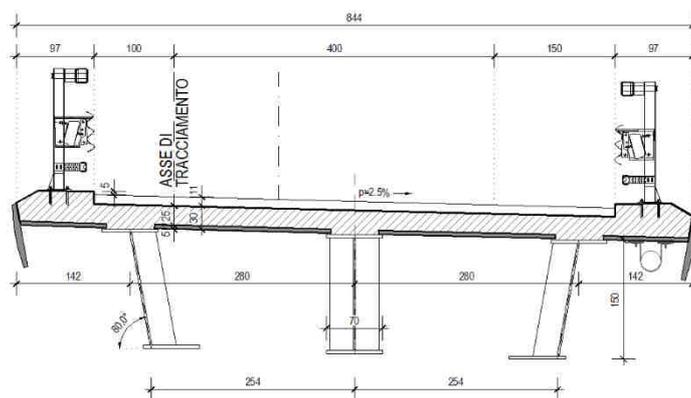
Sezione trasversale ortogonale alle travi principali – Sottovia svincolo SS.125 – rampa 5
